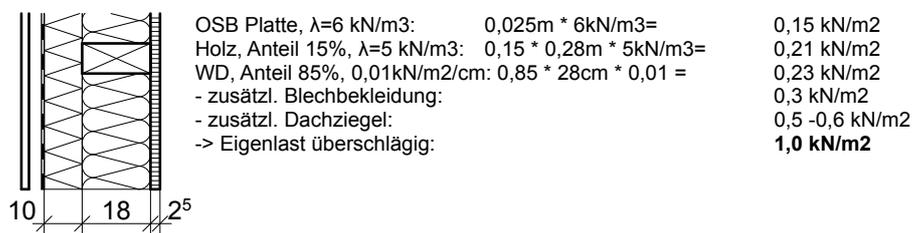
Nichttragende Außenwandkonstruktion, Holzrahmenelement
